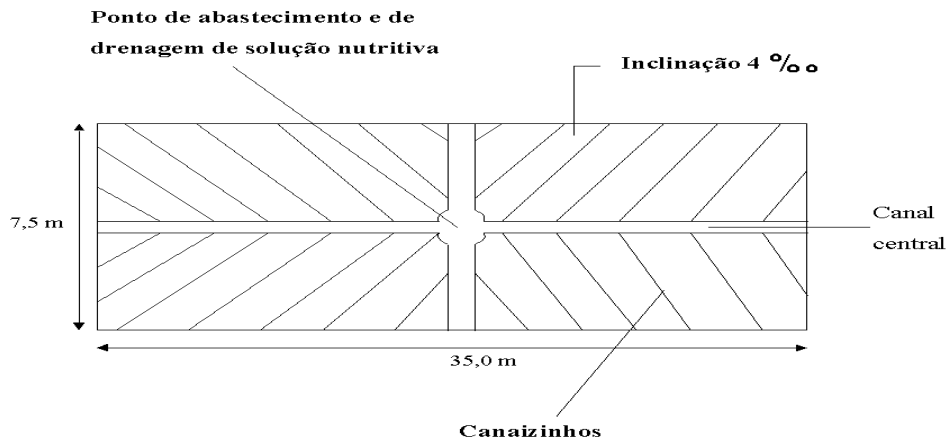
Planta de uma das balsas da sementeira/viveiro
